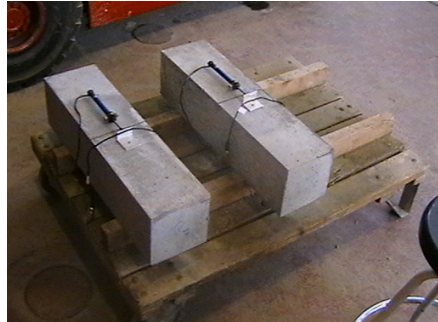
Probetas prefisuradas preparadas para ser llevadas a la cámara.
